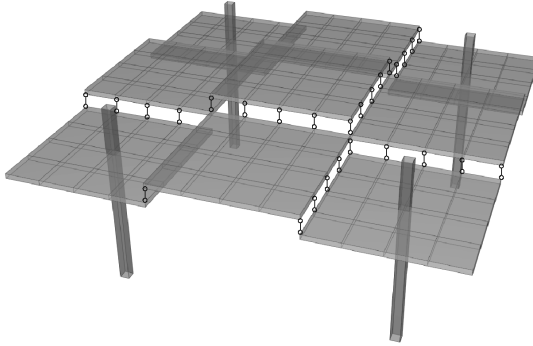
Розрахункова модель сталезалізобетонного безбалкового перекриття
